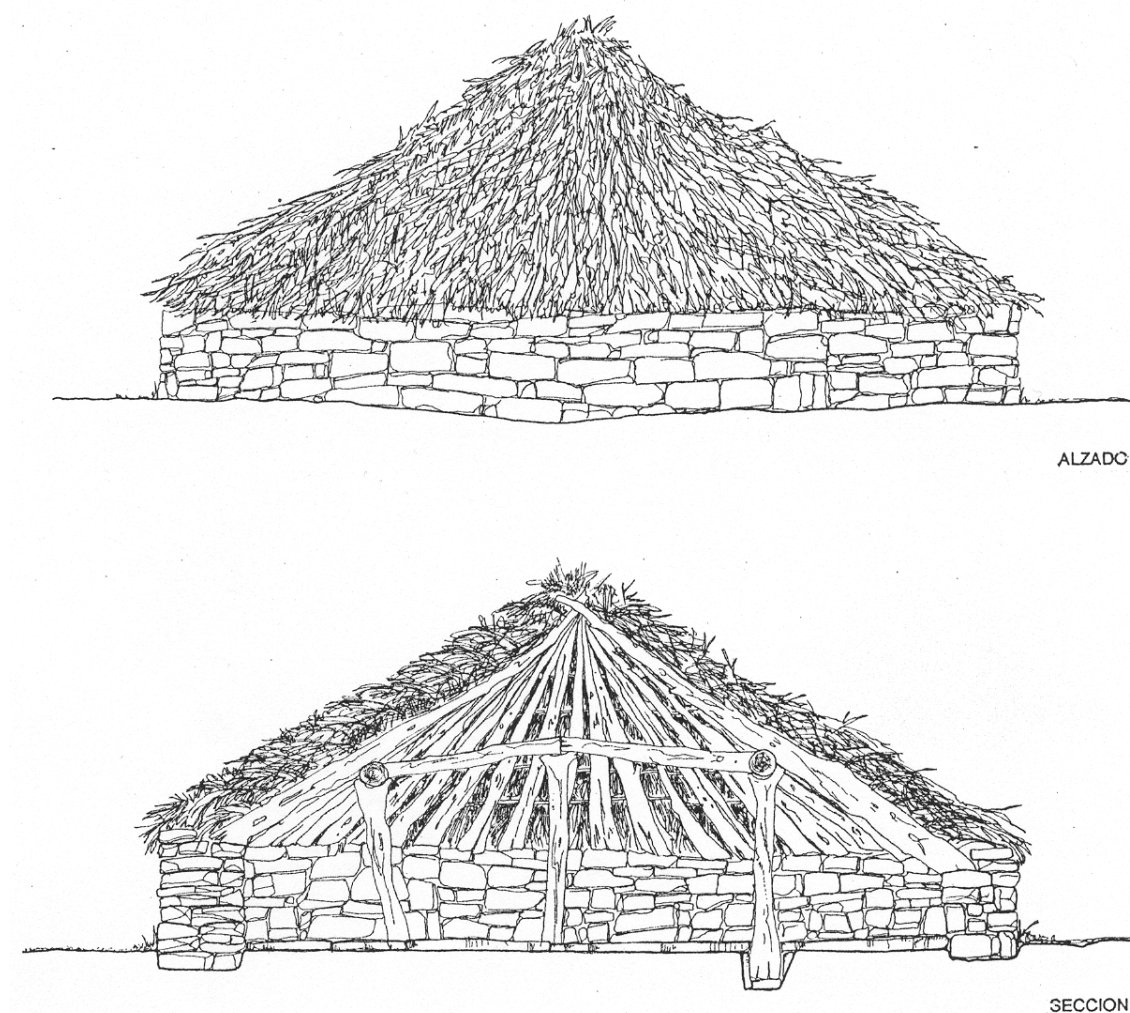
Propuesta de alzado y sección de cabaña circular
